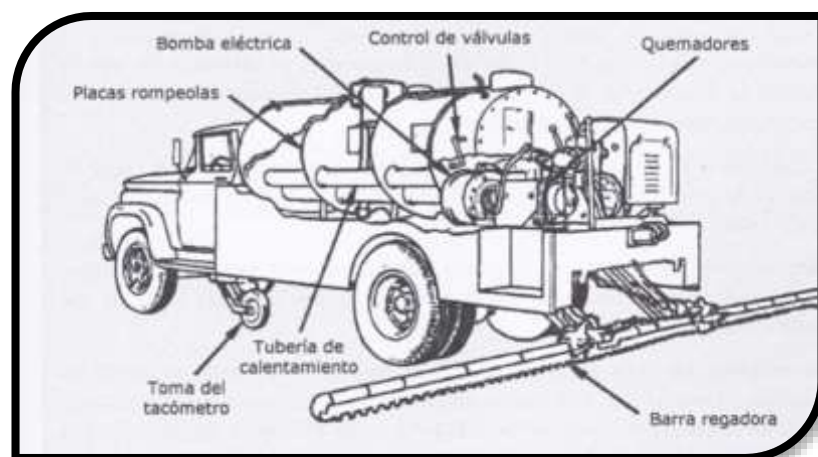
CAMION IMPRIMADOR PARA APLICACIÓN DE CEMENTO ASFALTICO PEN
